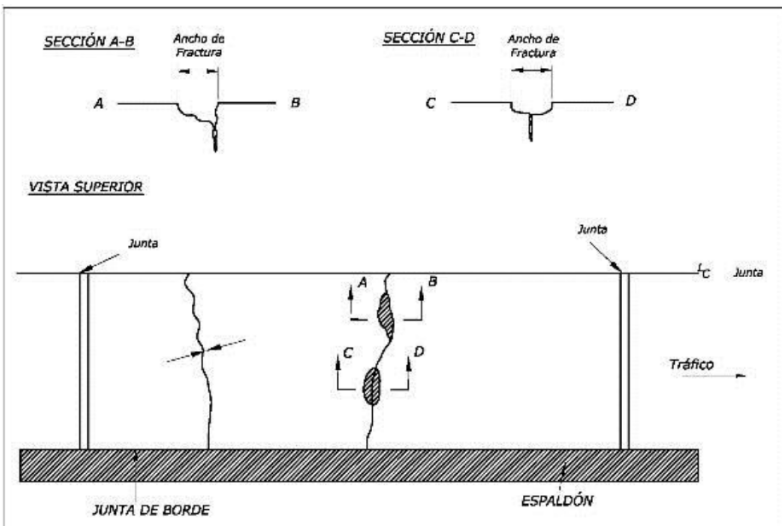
Esquema Grieta Transversal- Pavimento Rígido
